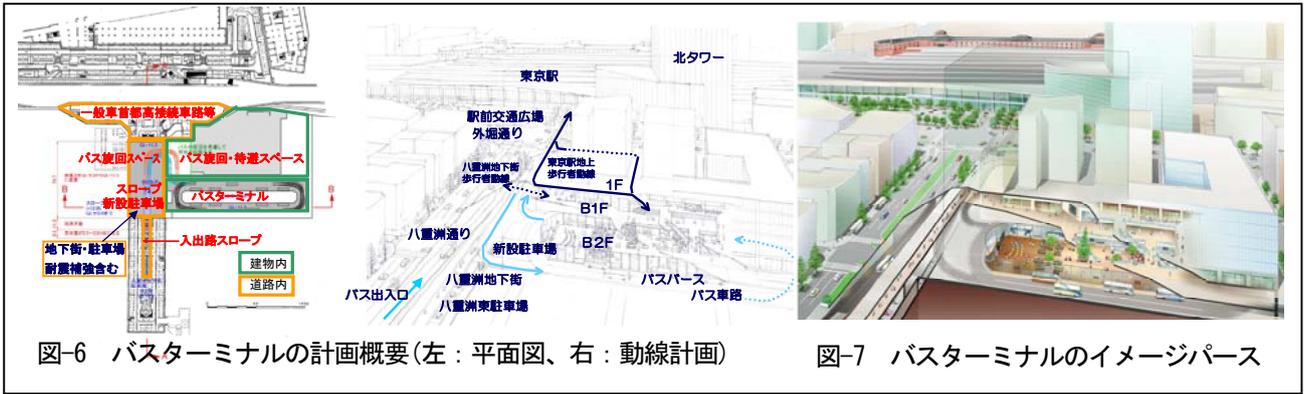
バスターミナルの計画概要(左：平面図、右：動線計画)
